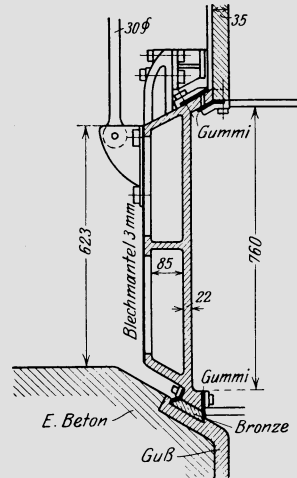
Zylinderventil der Schachtschleuse Minden. Querschnitt und Dichtung. Maßstab 1 : 20.
